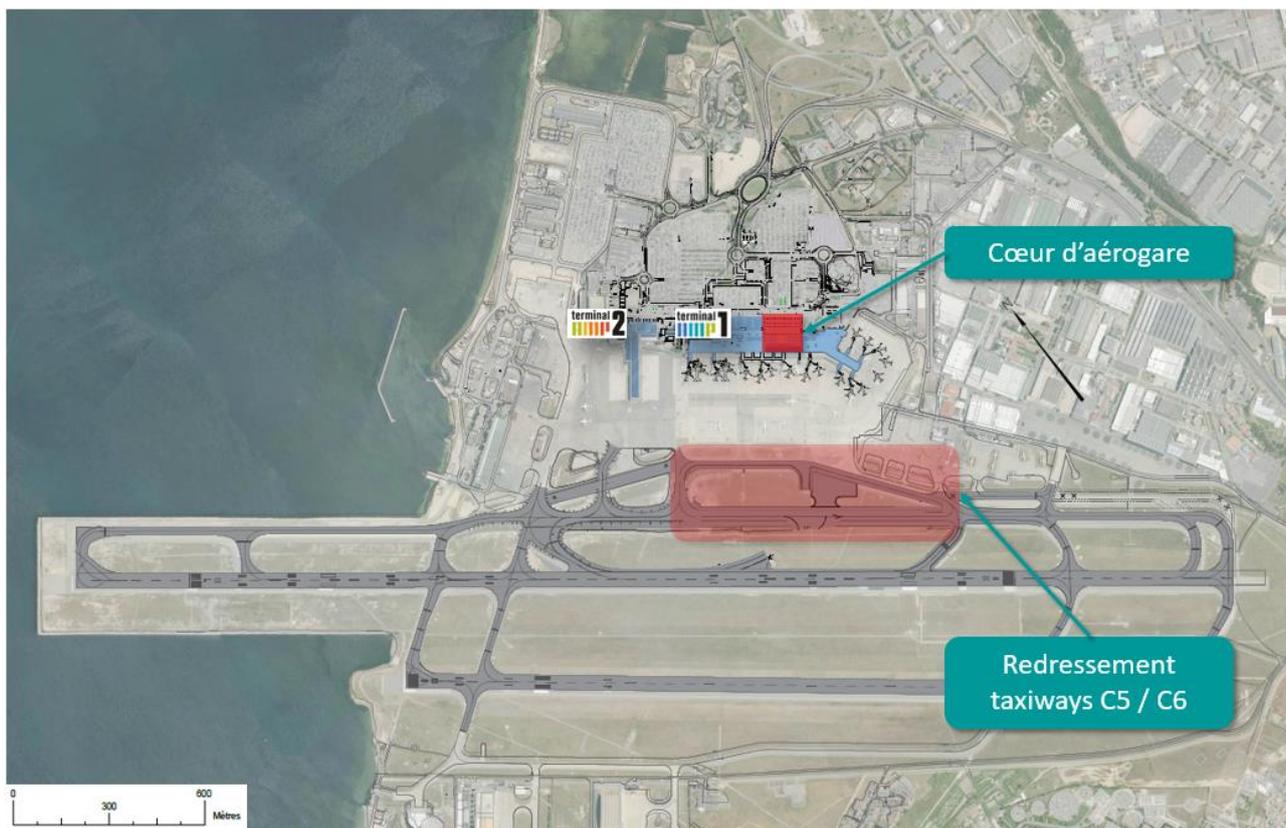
Plan masse de la situation avec la tranche ferme (2023) (source : dossier)
